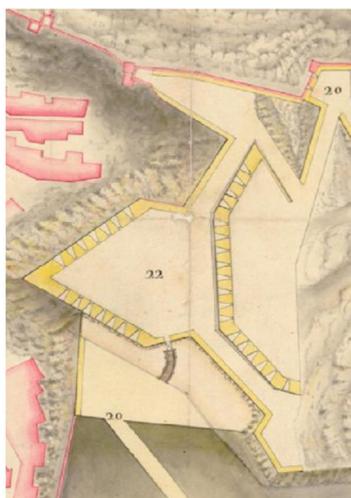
Detalle del baluarte con caballero proyectado por Montaigut, del “Plano del castillo de Alicante con el proyecto de algunas obras”. Antonio Montaigut. IHCM. Plano A-02-08.
